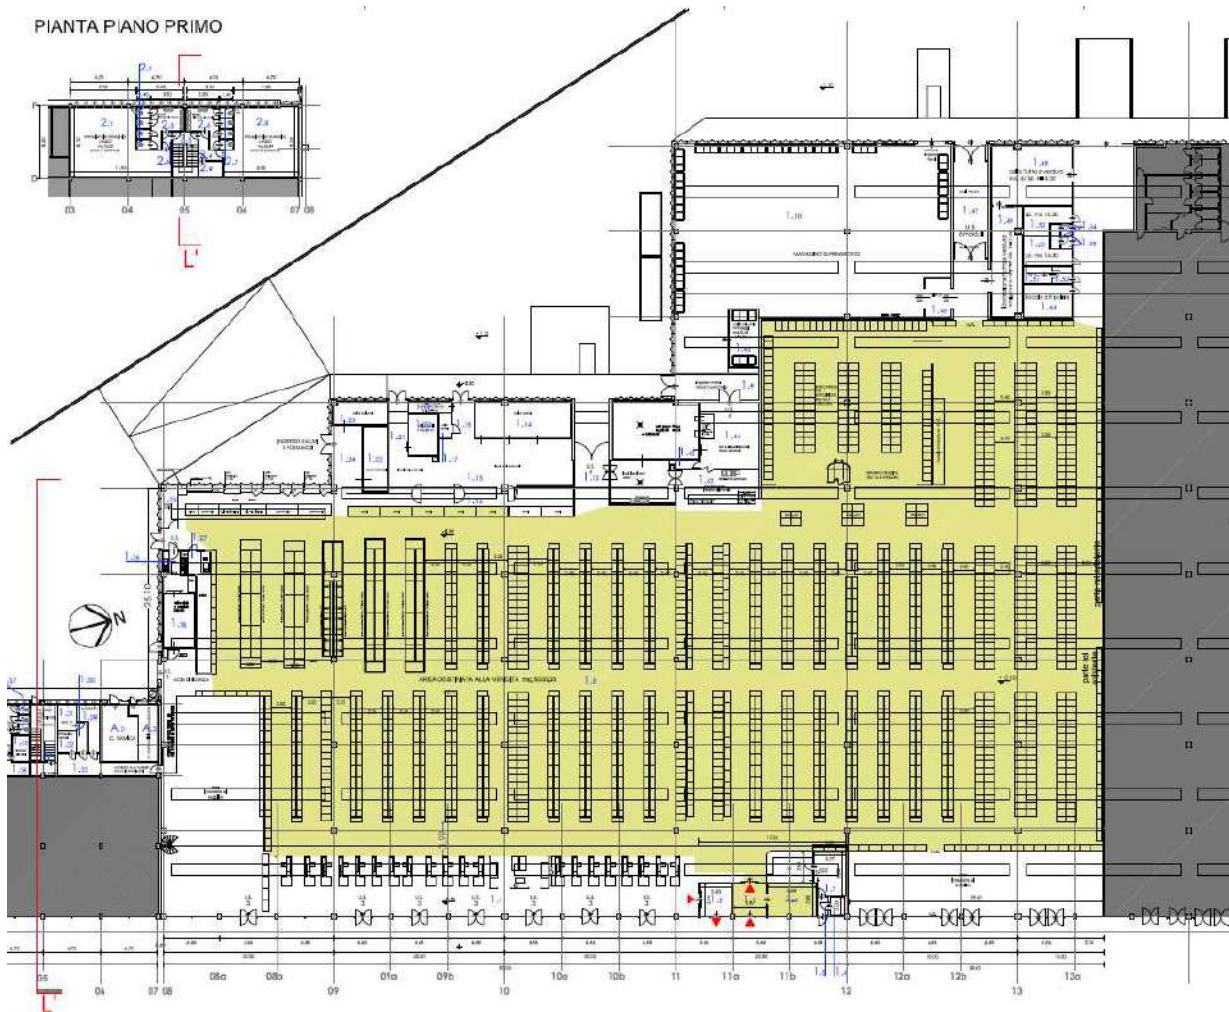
Pianta stato di progetto (estratto Tav. 2.1)
